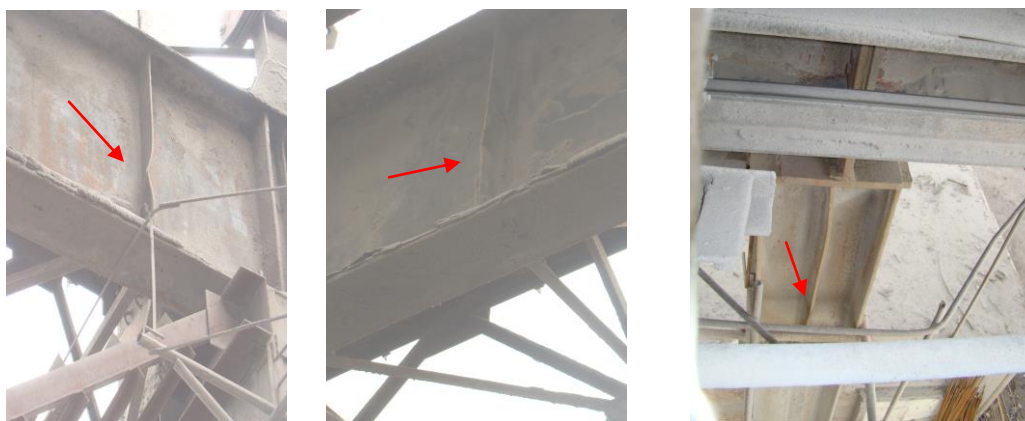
Местное искривление поперечных ребер подкрановой балки ПБ А/5–6 и искривление центрального ребра в опорной тумбочке подкрановой балки на колонне В5
